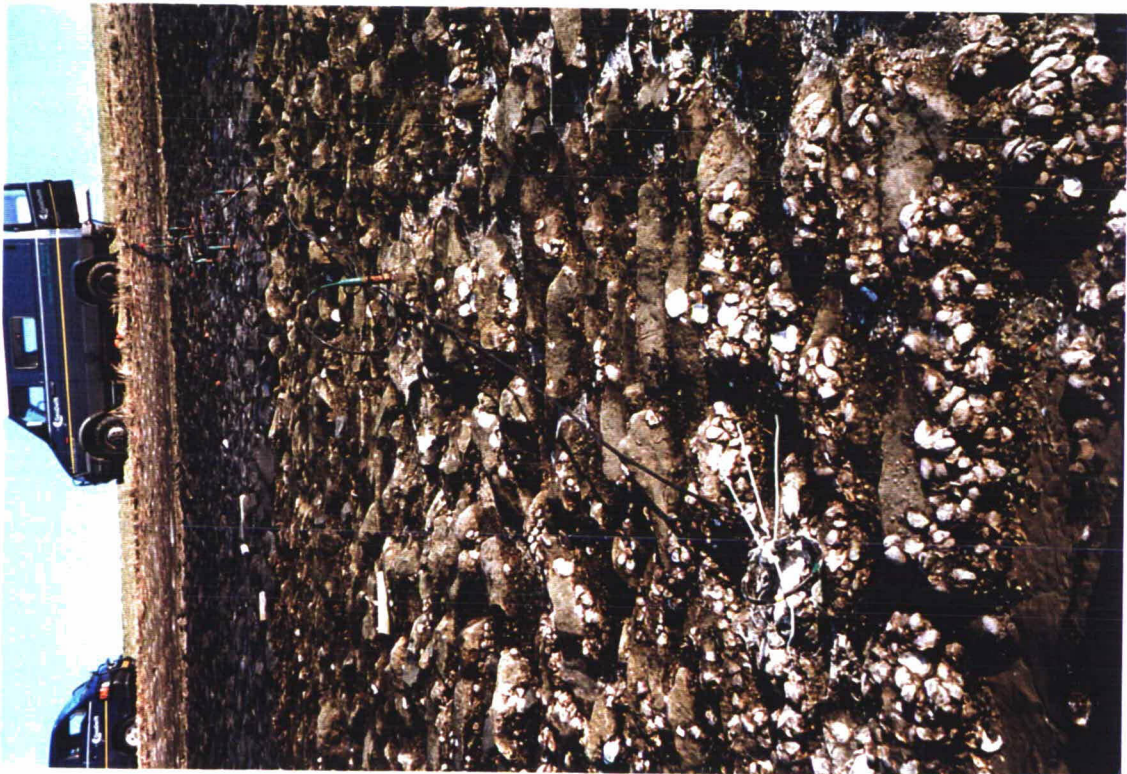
Meetopstelling van de getijmeting bij dp 37+25m in bekledingsvak 17299
